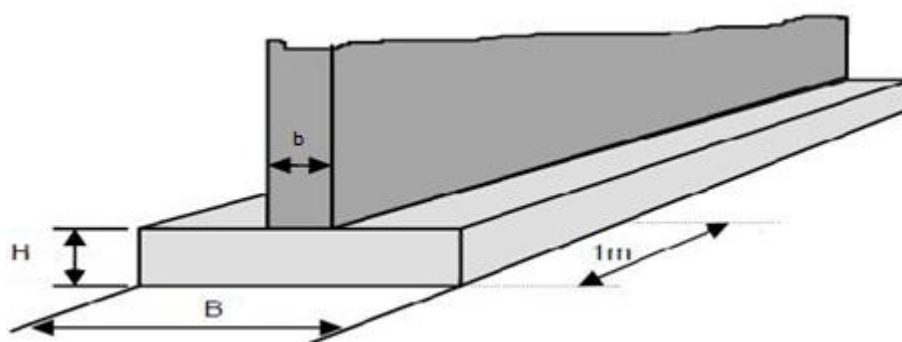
semelle filante sous un mur voile (KASSOUL, 2016).
